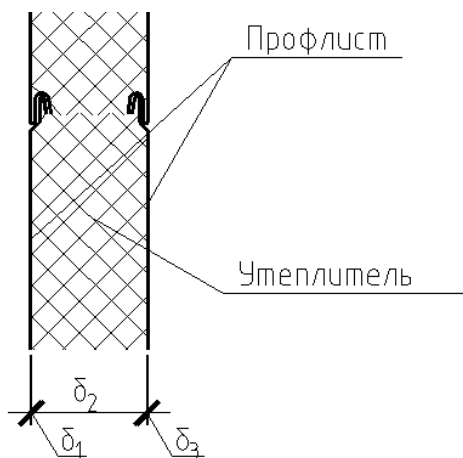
Расчетная схема стеновой ограждающей конструкции
